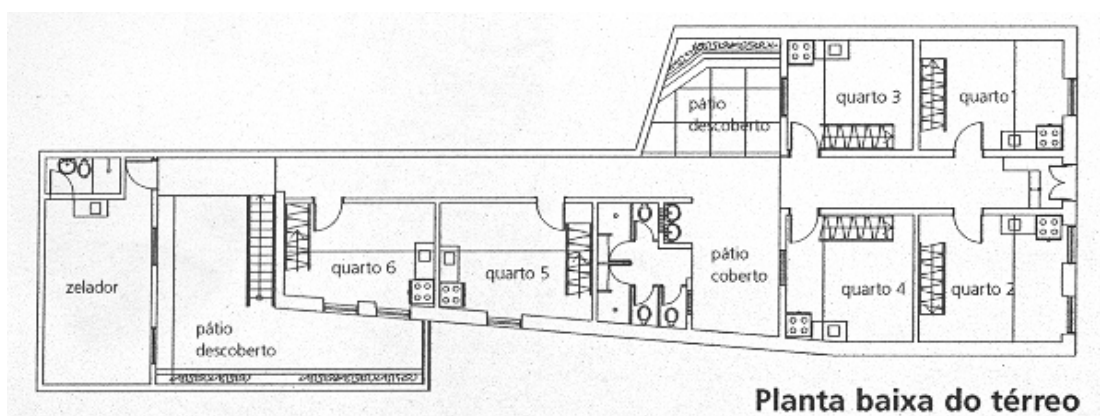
Cortiço na Travessa do Mosqueira, 20 – Planta baixa do térreo (SECRETARIA, 2000, p. 40).
